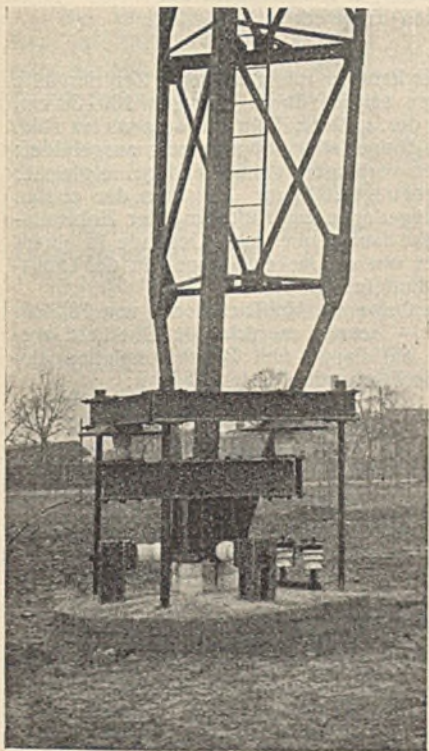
Funktürme in Hamburg. Auflagerung eines Mastfußes.
